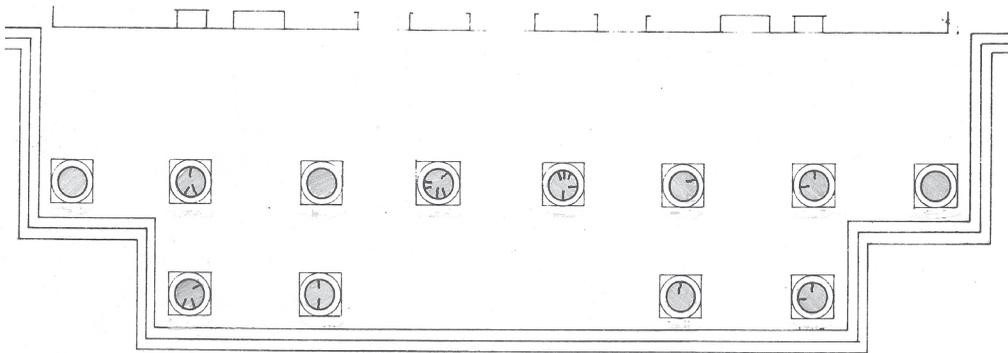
Planimetría atribuida por Esmirna Barrientos. Planta del pórtico del teatro de la ciudad de Quetzaltenango. 1995. Tesis de maestría de la Facultad de Arquitectura, USAC.
